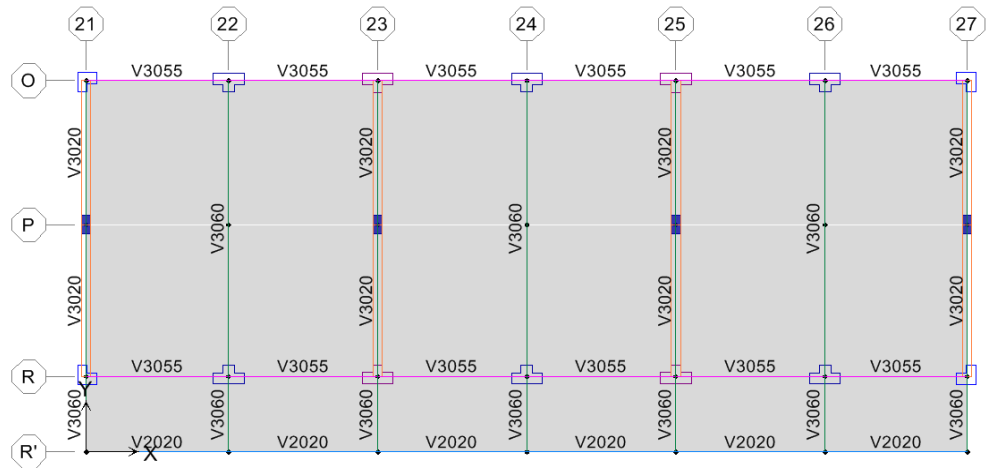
Encofrado de techo de 1er nivel - Pabellón 01 (aulas)
